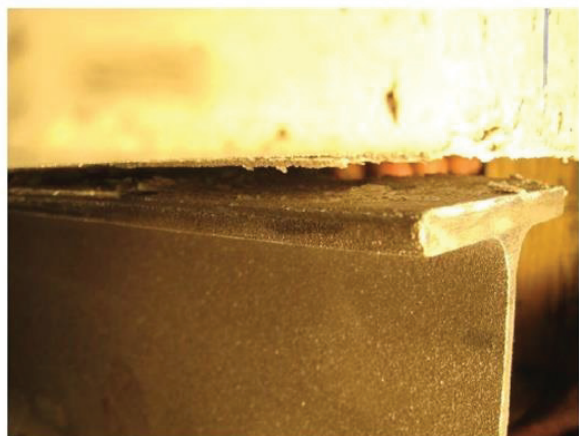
Déformations en section centrale des poutres AB13 et AB15
